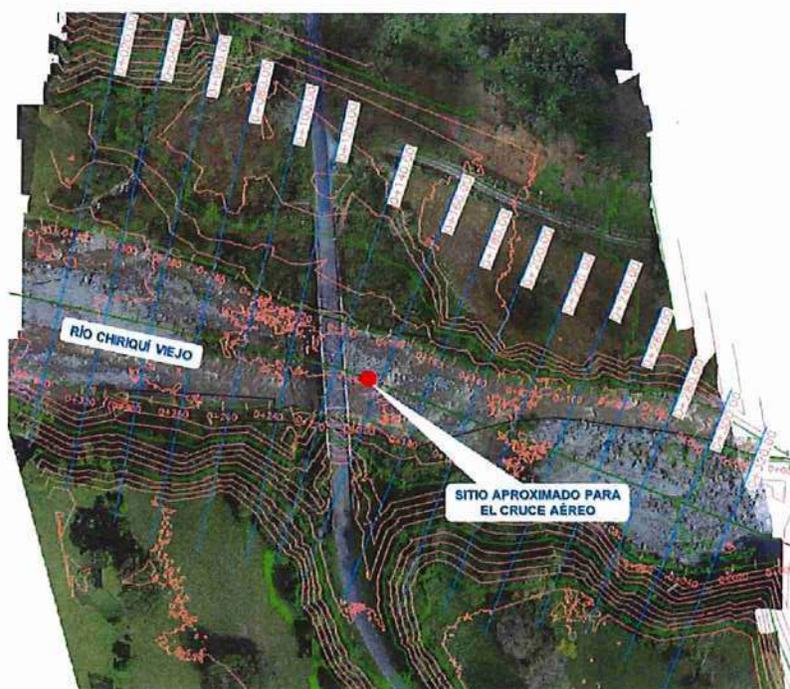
Vista en planta del levantamiento topográfico y secciones del río Chiriquí Viejo.
